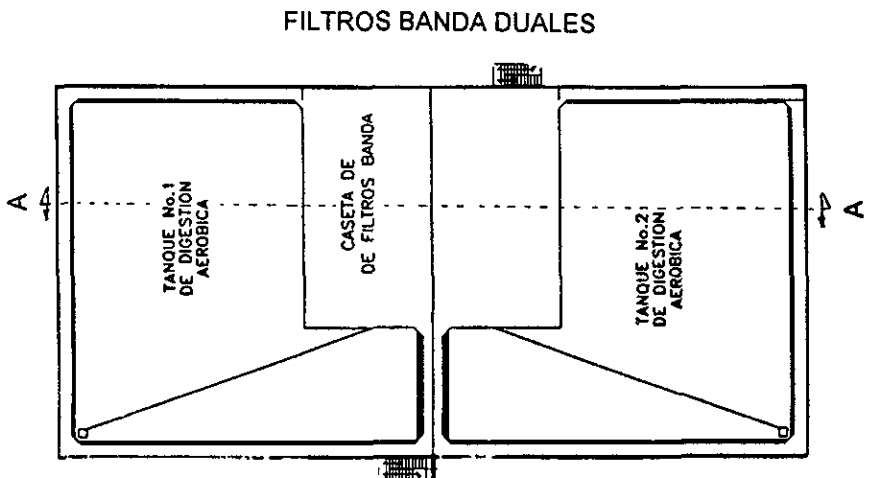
Planta de Tanques de digestión de lodos y filtros banda
